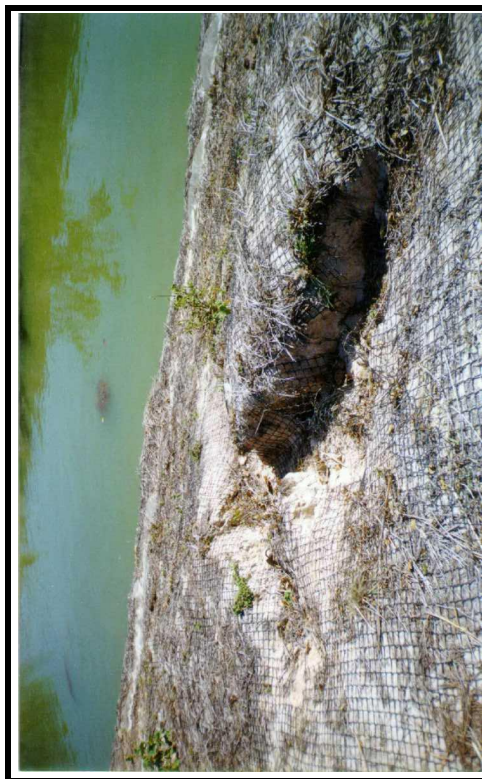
/44 - Trecho do Canal do Trabalhador onde existia a hidro-semeadura. Observa-se o desenvolvimento de sulco de erosão.
